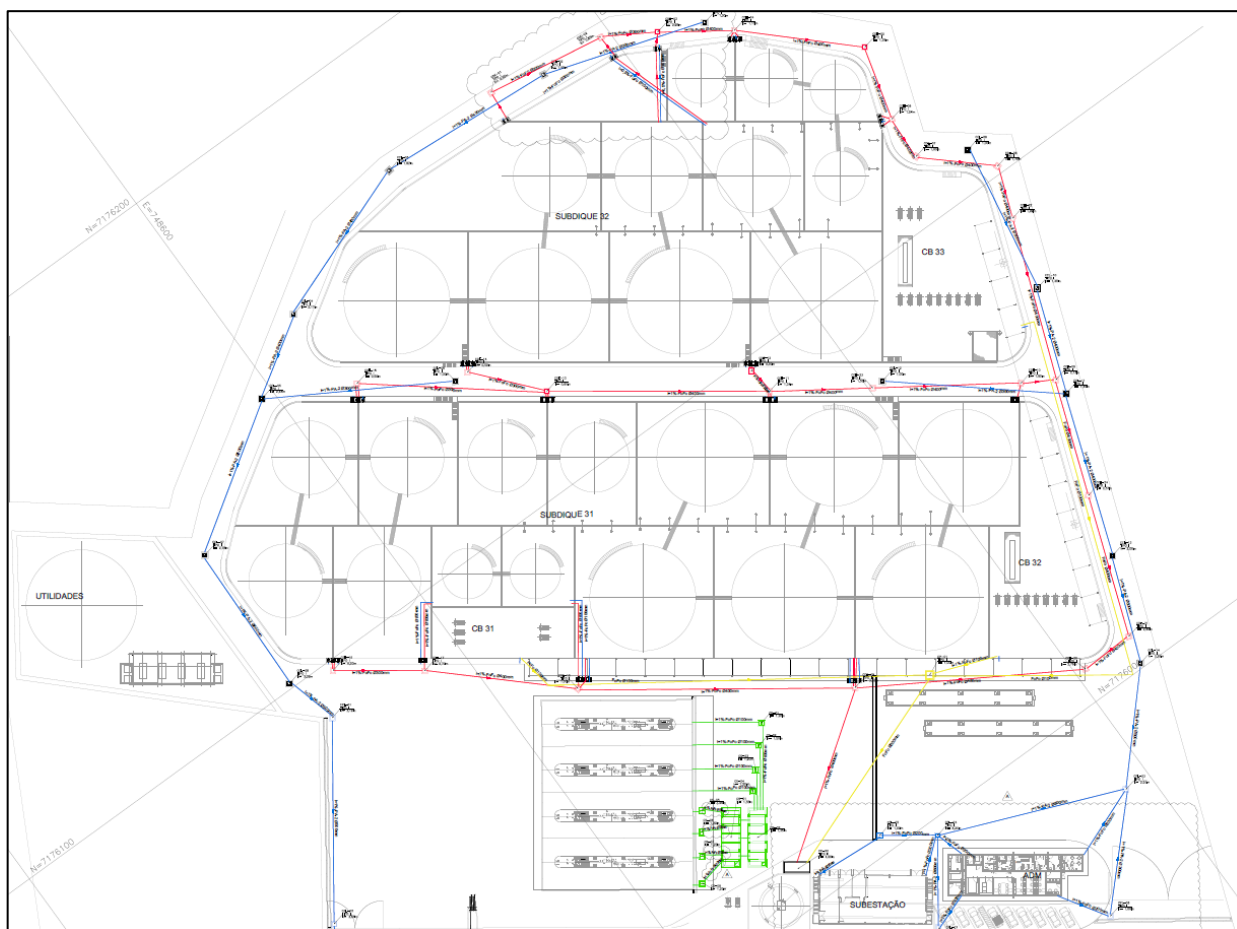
PLANTA DE DRENAGEM – TERMINAL 3
